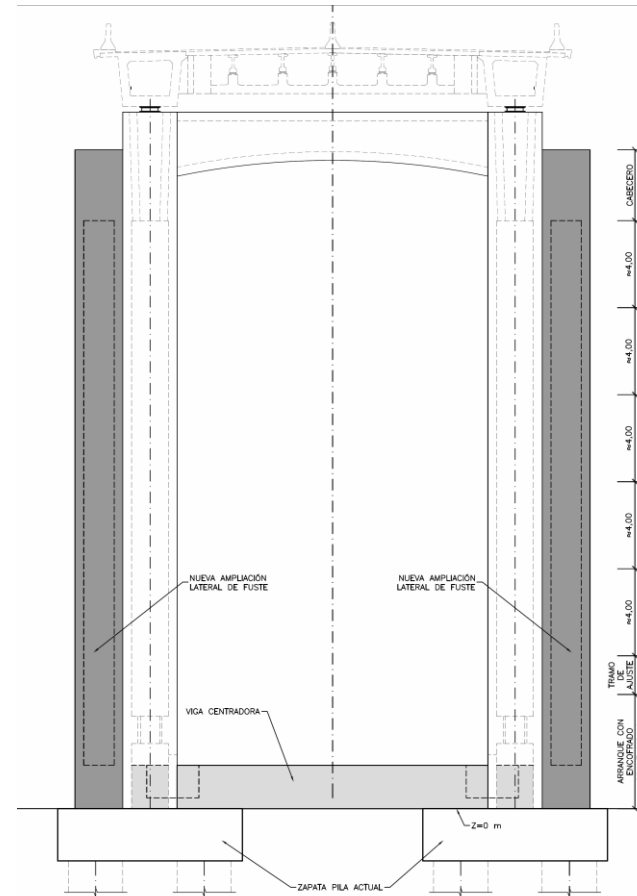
Ejecución de viga centrado y ampliación lateral de las pilas de retenida P-13 y P-16
